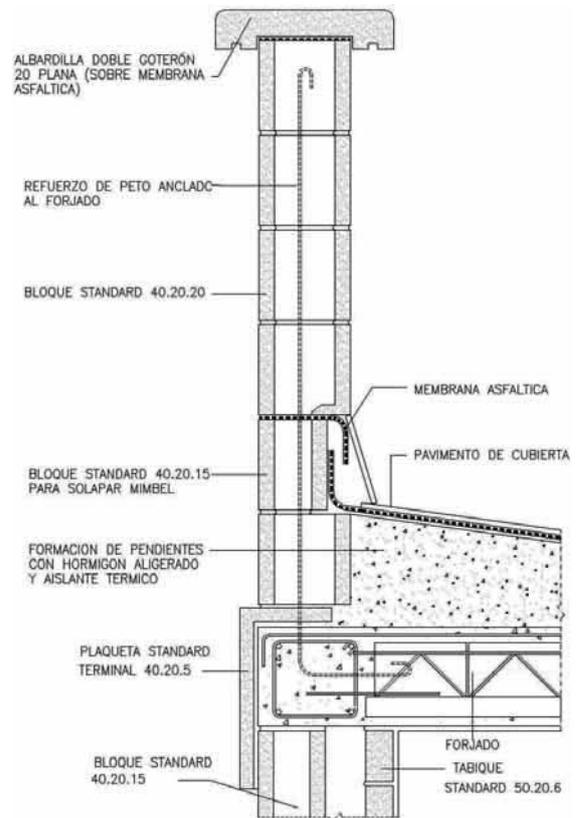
Sección de encuentro de muro de 1 hoja de bloque hueco en el peto de cubierta.
